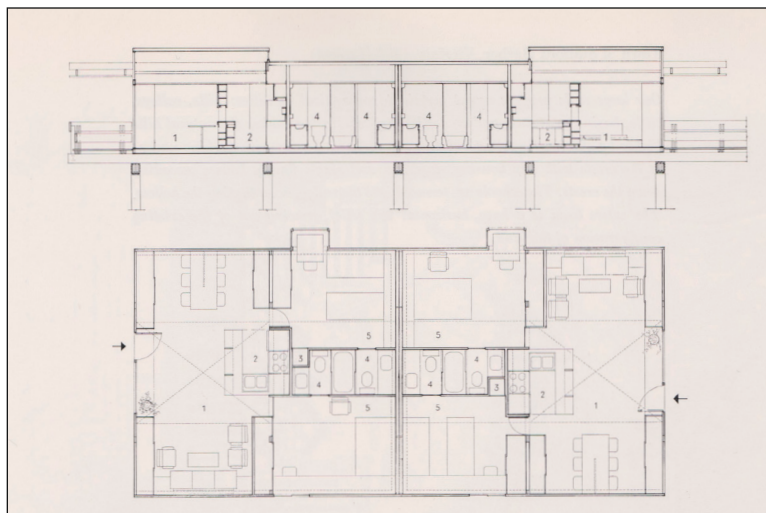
Längsschnitt und Grundriss von zwei Zweizimmerwohnungen
